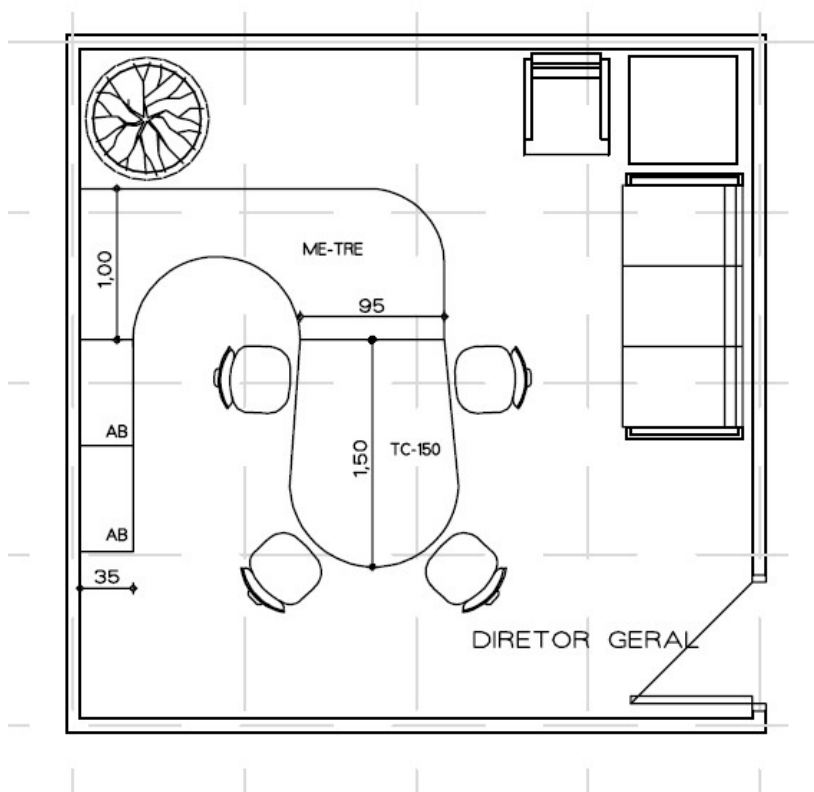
Planta baixa sala Diretor Geral/Secretário Adjunto. Área aproximada: 20m²
